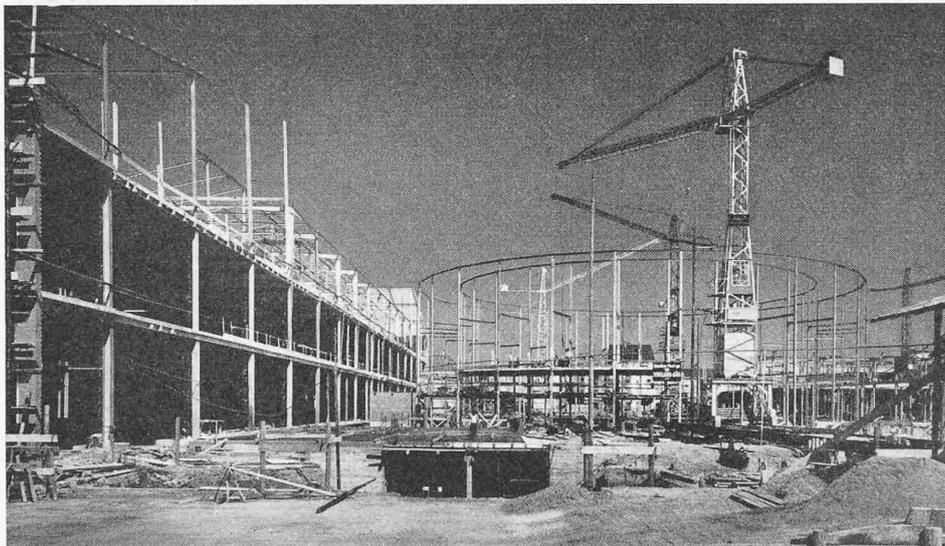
Blick gegen den im Bau befindlichen Rundhof
